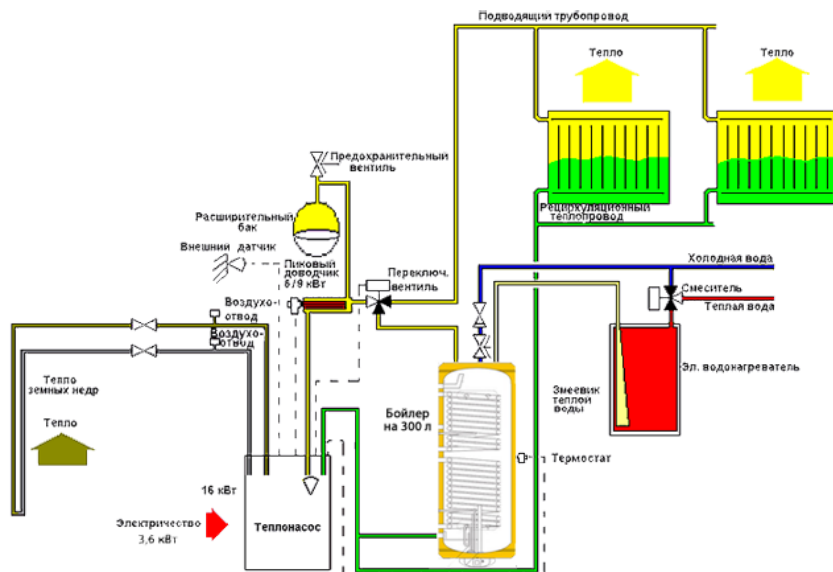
Схема отопления и горячего водоснабжения жилого дома с использованием ТН.
